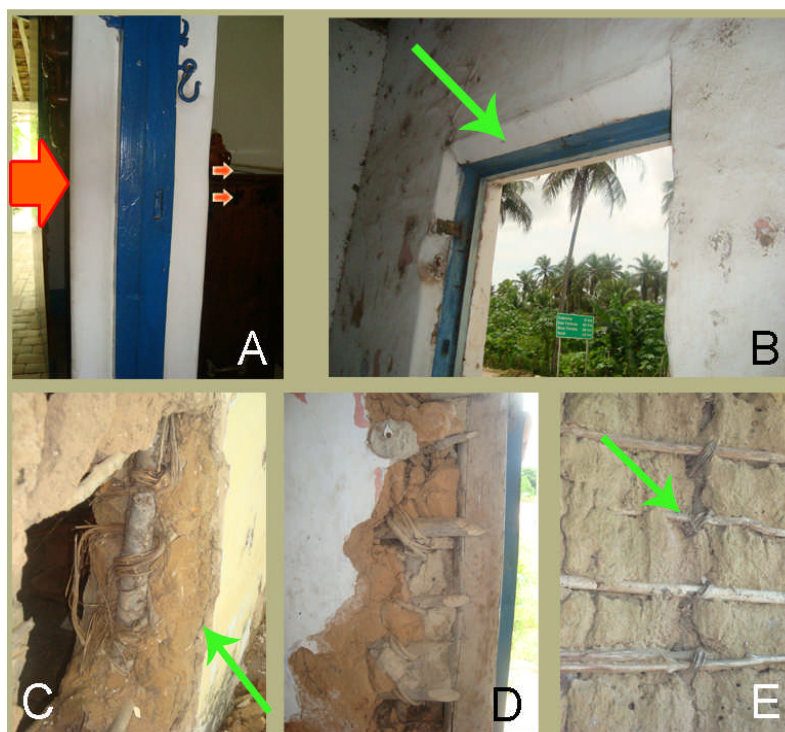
Paredes de taipa-de-mão e detalhes construtivos
